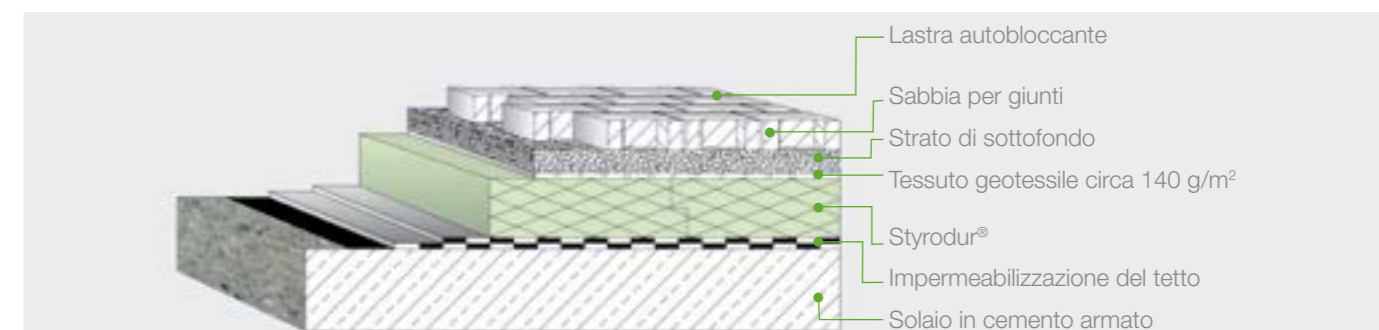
Struttura di tetto parcheggio con lastre autobloccanti su uno strato di sottofondo.
